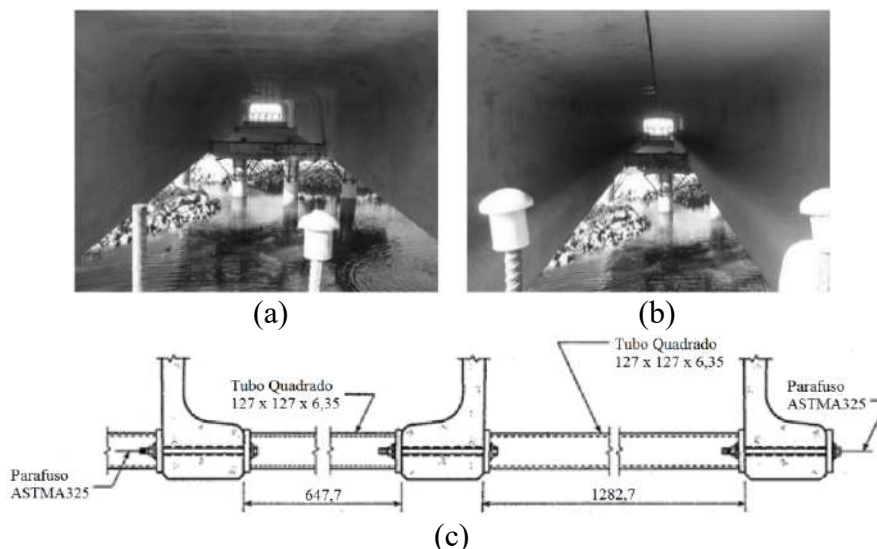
Diafragmas de tubos vazados: (a) vista inferior da instalação em uma longarina, (b) vista inferior da instalação entre longarinas adjacentes e (c) detalhe construtivo [239].
